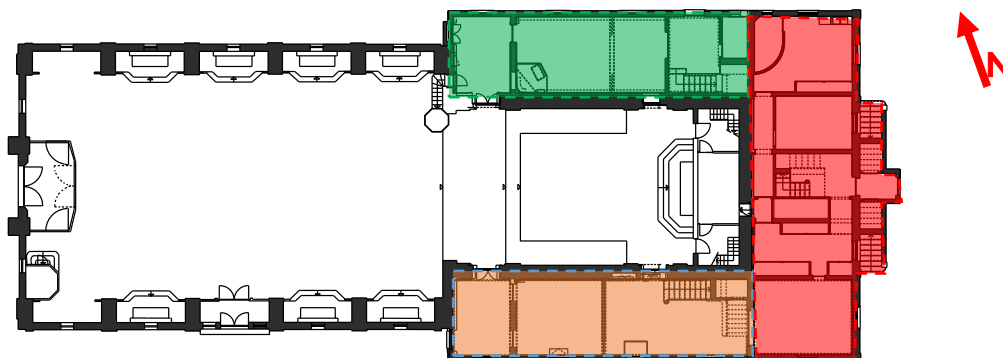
Planta de levantamento arquitetónico da igreja (sem escala), com identificação dos corpos laterais nordeste (verde) e sudoeste (laranja), bem como o corpo posterior (vermelho)
